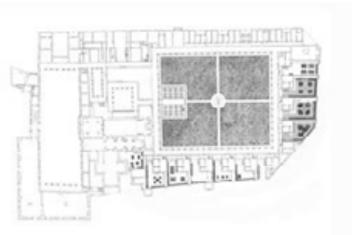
Planta de conjunto. Monasterio d'Ena.
